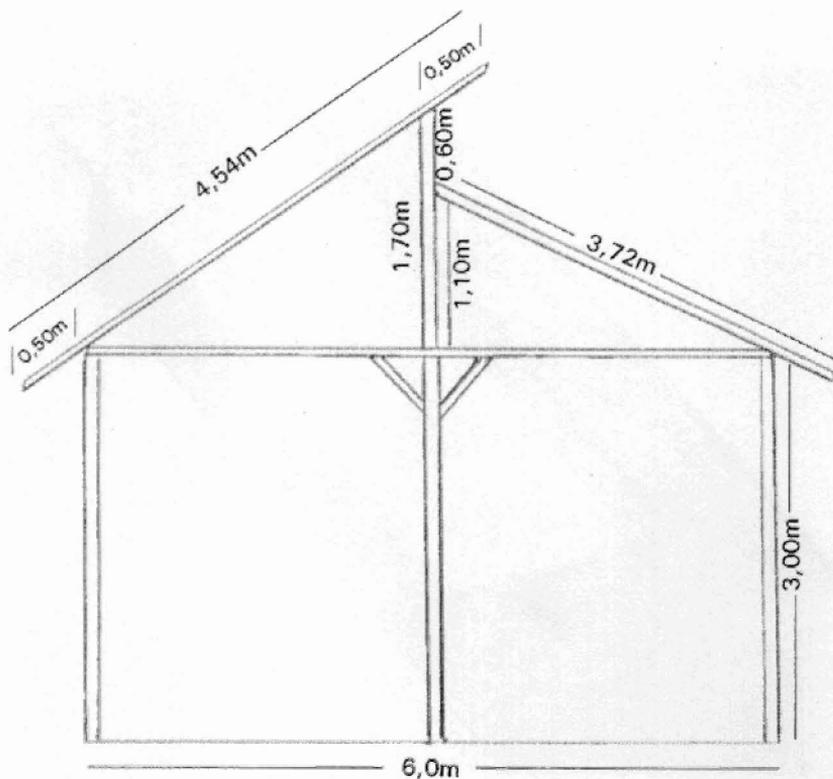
Detalhe do lanternim no telado com cobertura plástica, tipo capela, com as dimensões de 12,0m x 6,0m.
